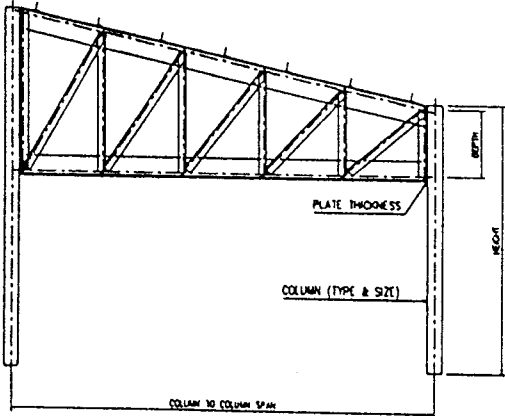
รูปประกอบคำบรรยายคำสั่ง SUPPORT TYPE กรณี FLAT ROOF TRUSS
